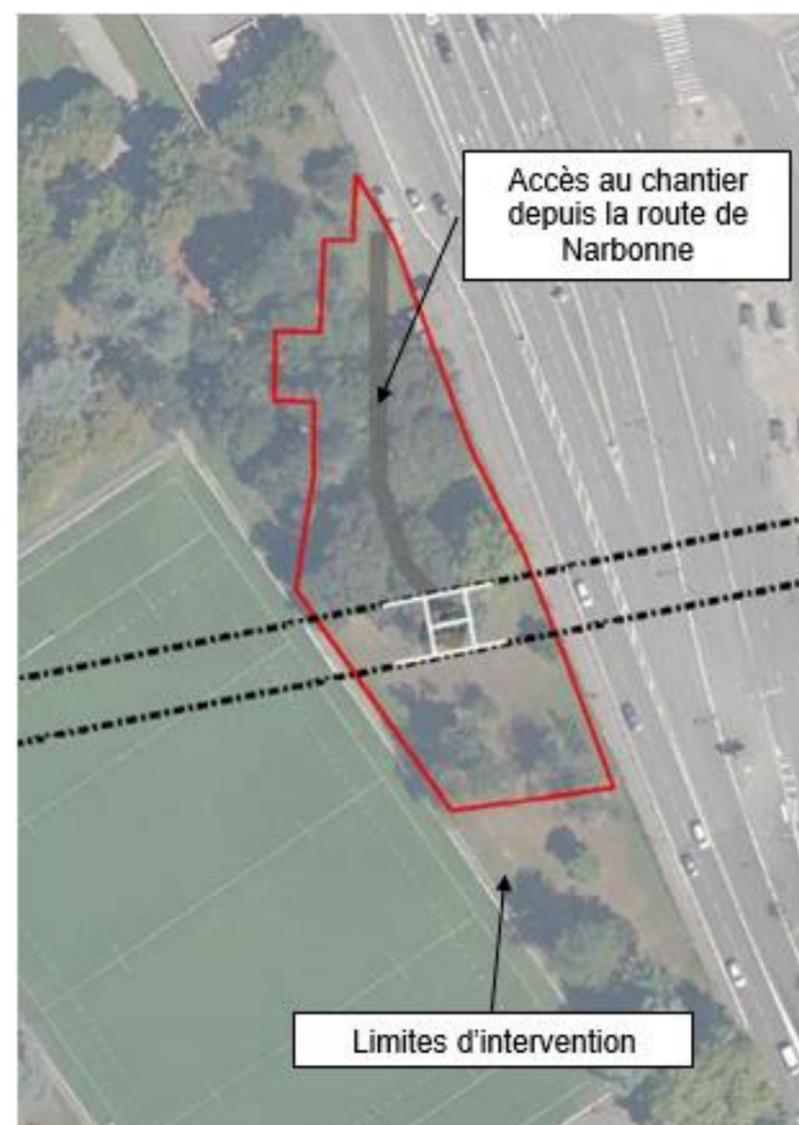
Plan de la zone travaux du pylône 5 (Source : Groupement POMA, 2018)
